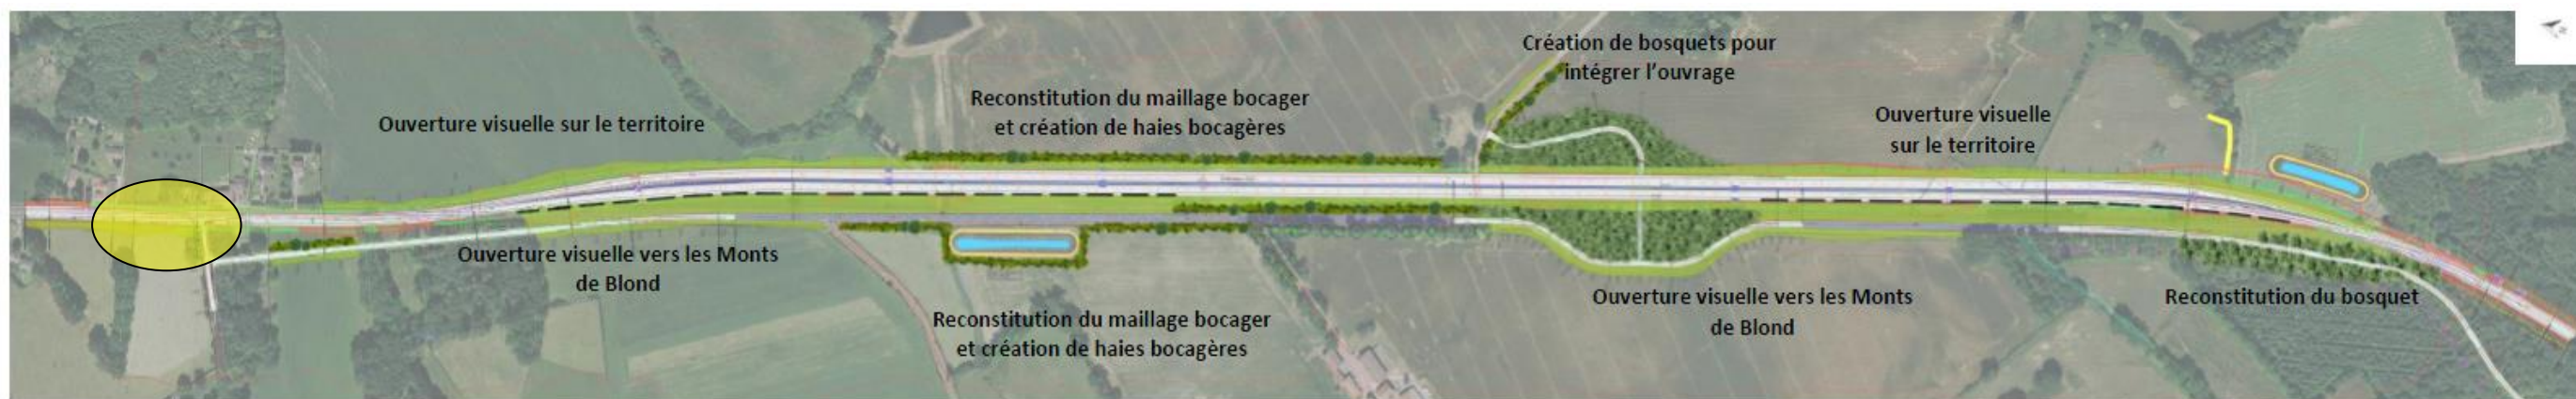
Vue en plan des aménagements paysagers sur la section de Chamboret
